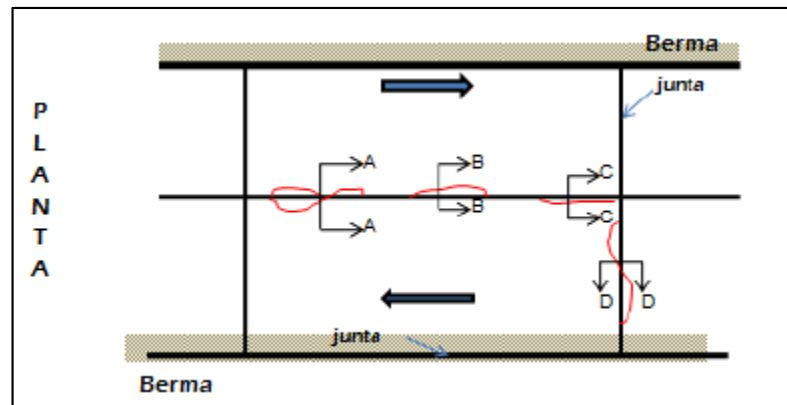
Esquema de la vista en planta del descascaramiento de junta.
